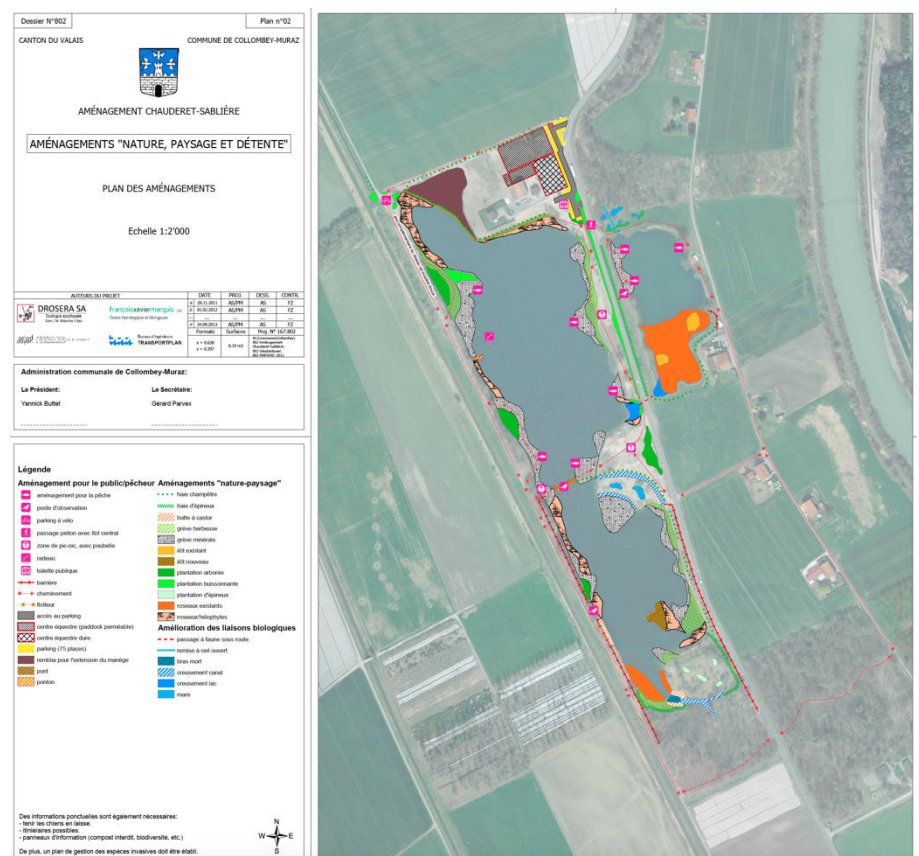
Plan des aménagements, secteur Chauderets-Sablère
